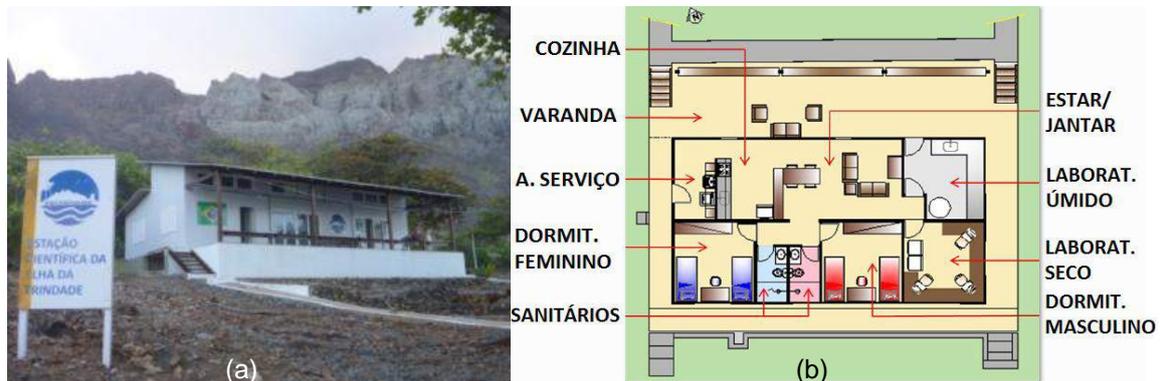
Em (a), vista geral e em (b), planta com layout da ECIT
